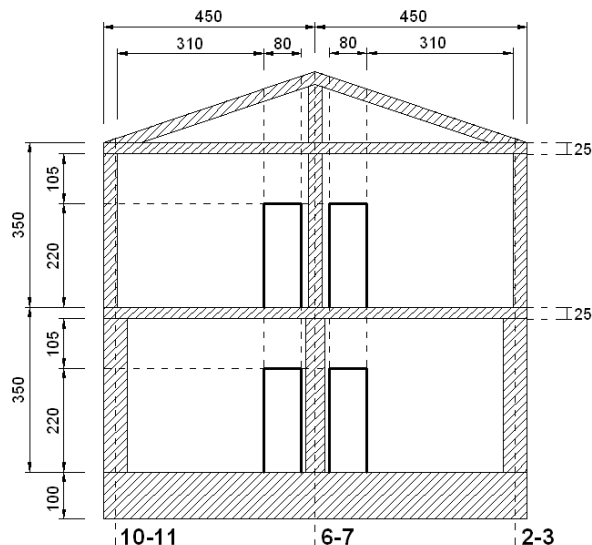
e – Parete 10-6-2; Parete 11-7-3
